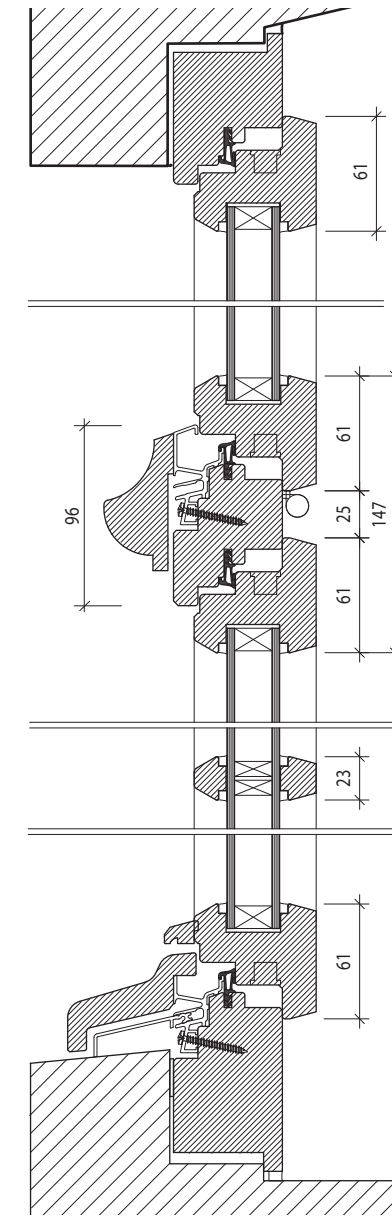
Fensternachbau in Holz mit adaptierten Standardprofilen. Ostfassade. (Plan: Haupt AG Ruswil)
